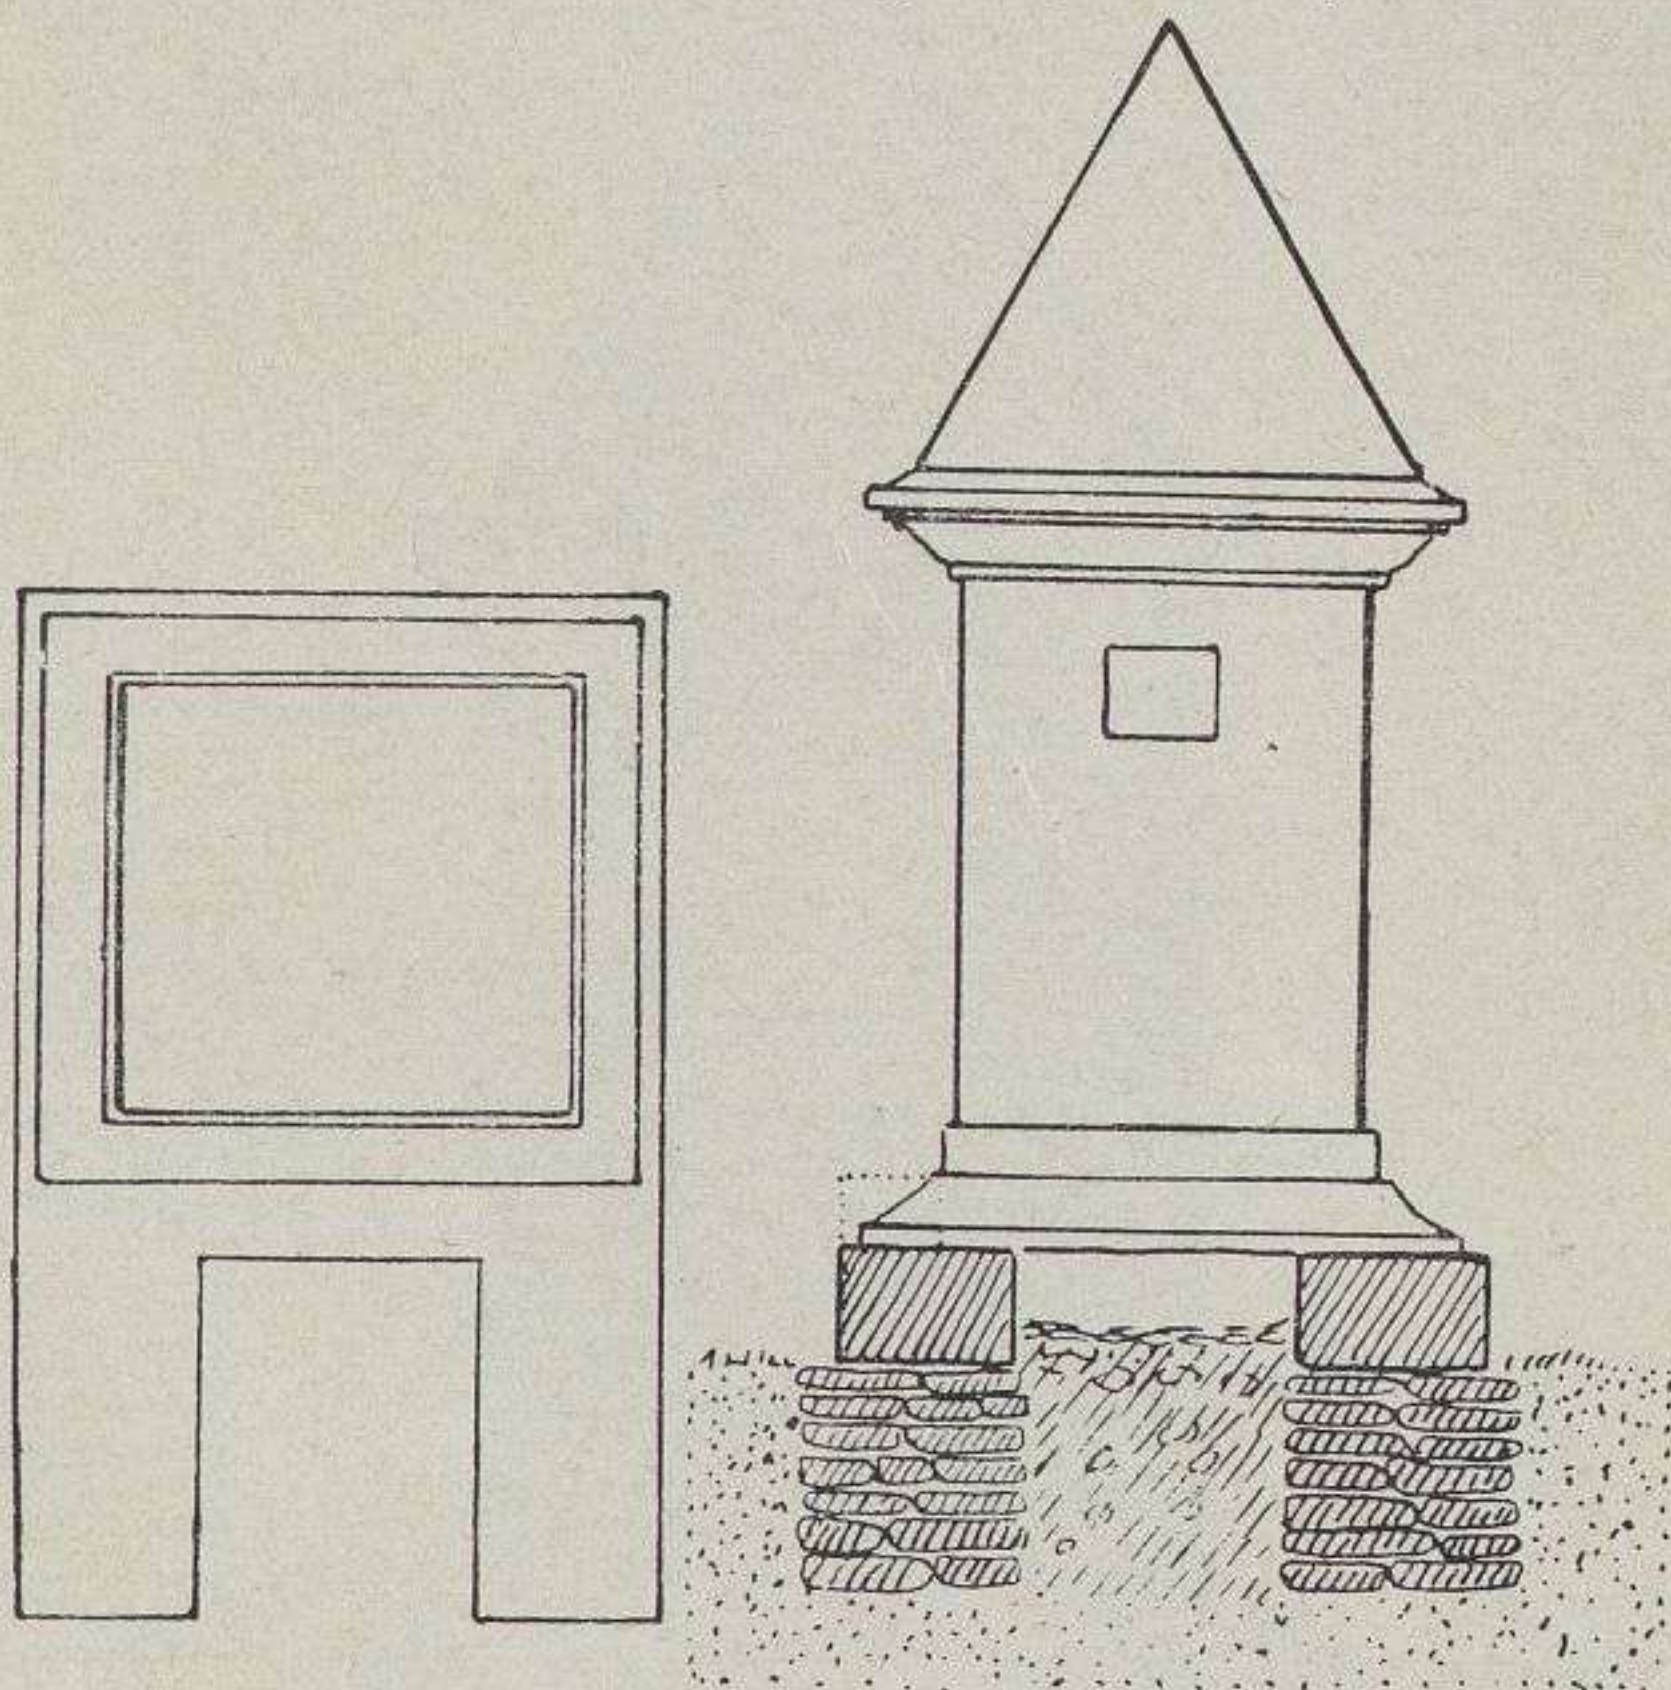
Planta y alzado de un mausoleo según Bonsor.
